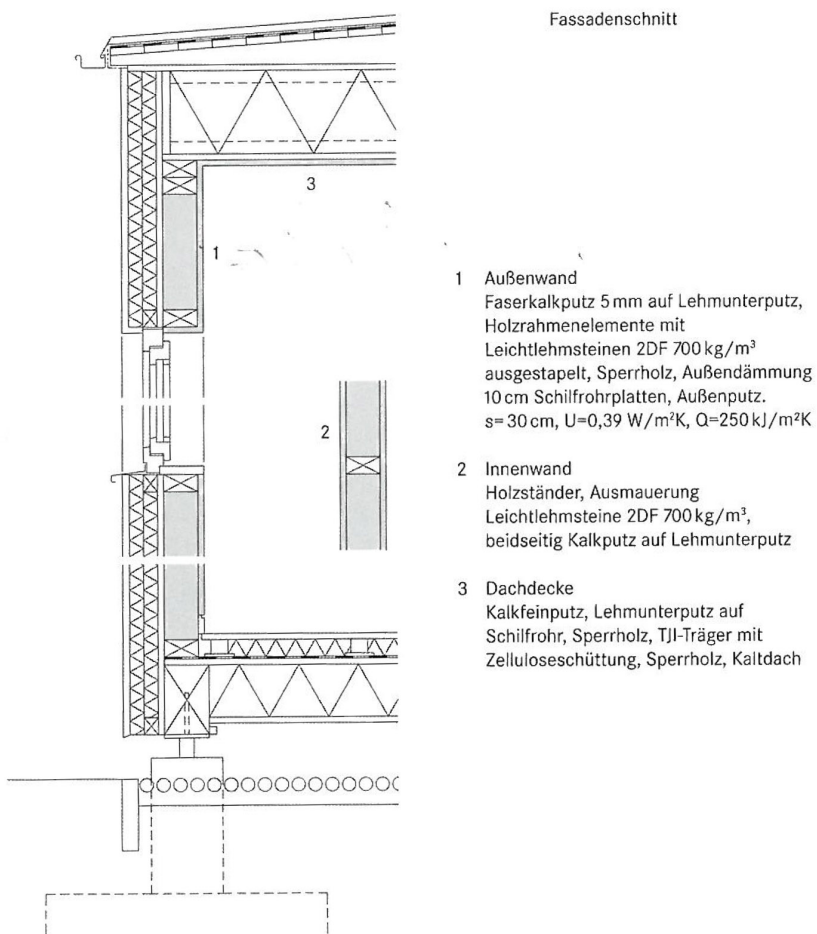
Fassadenschnitt. Wandaufbau. [Arch: Schauer + Volhard, Darmstadt]
